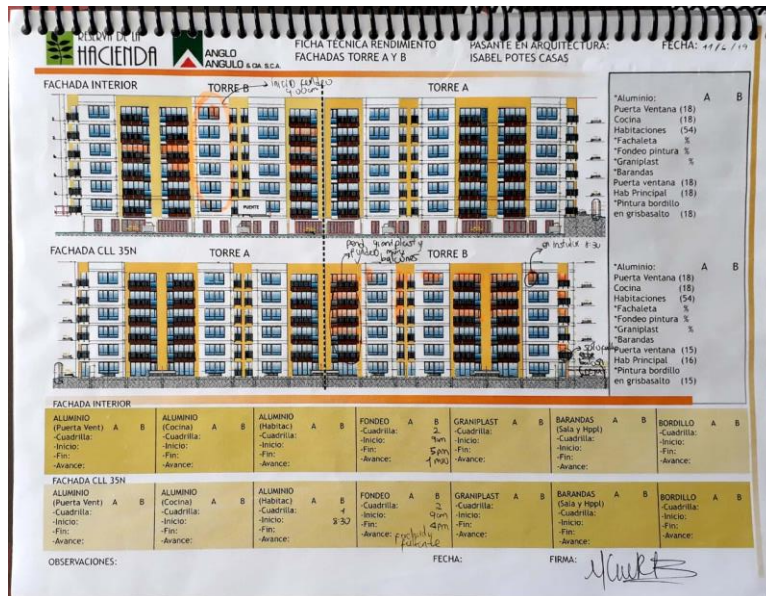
Ejemplo 1 implementación de ficha rendimiento de fachadas
